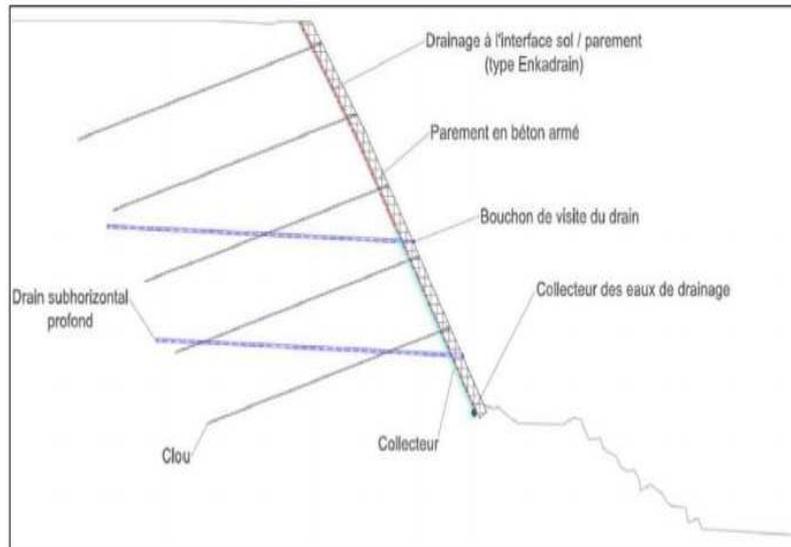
Coupe de principe de la solution retenue - (Source : INGEROP)
